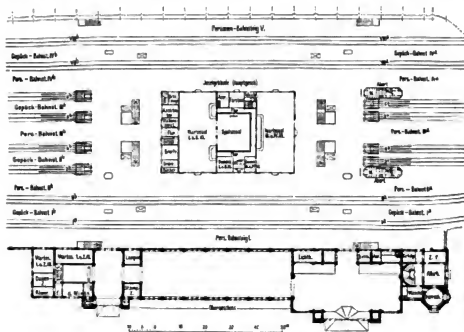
Grundriss in Höhe des Bahnsteigs.
